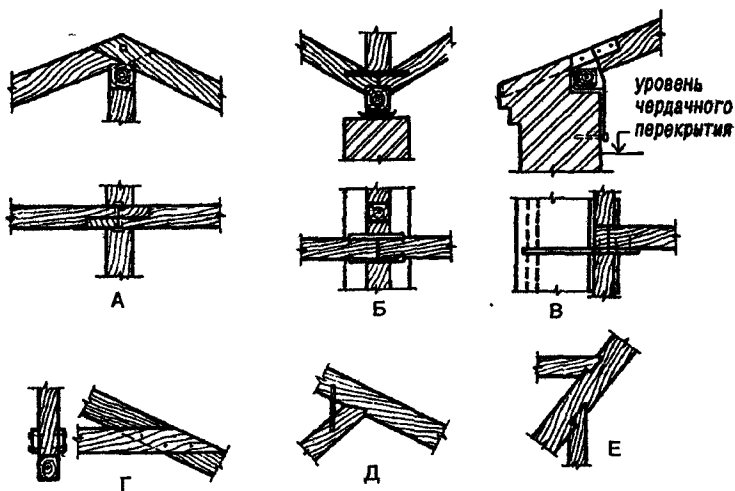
Детали узлов деревянных брусчатых наклонных стропил А—Е
